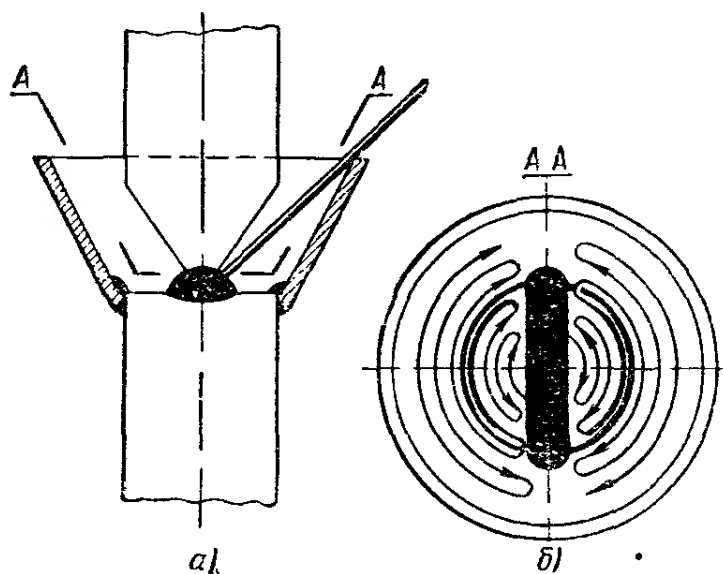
Ваннный способ сварки стыков вертикальных стержней
